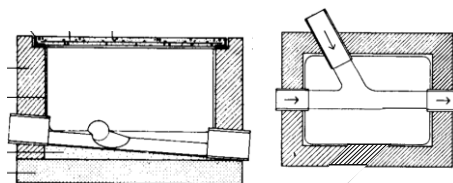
y 6.22. Detalle constructivo de la arquetas
